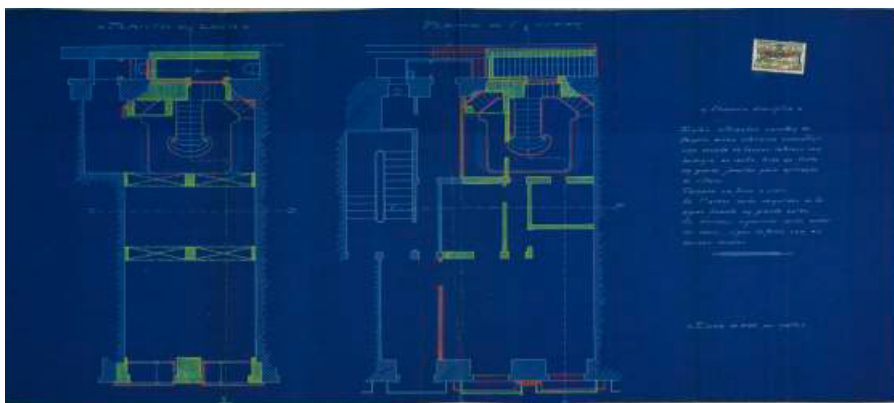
Edifício na Rua do Ouro, 172; alterações estruturais realizadas em 1911. Processo da CML n.º 6711.
